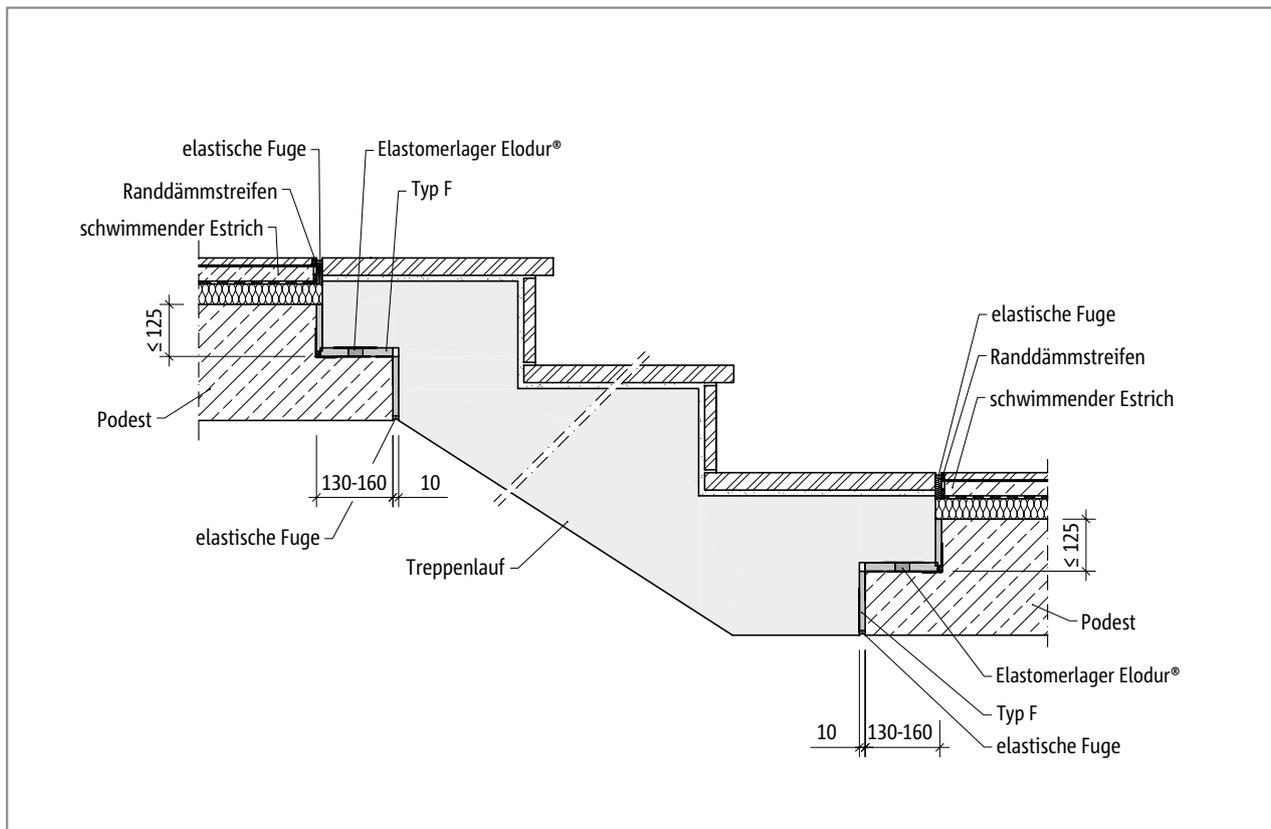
Schöck Tronsole® Typ F: Einbauschnitt
